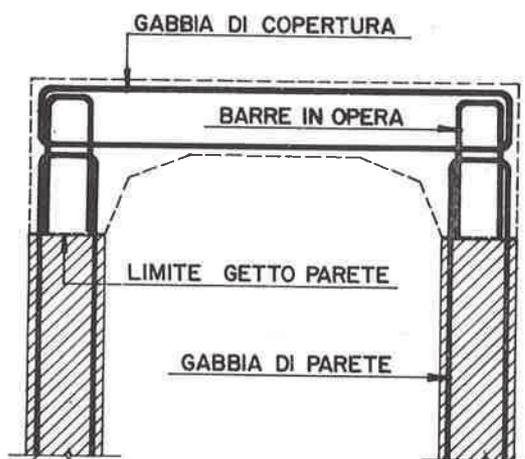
Collegamento per sovrapposizione copertura-parete
